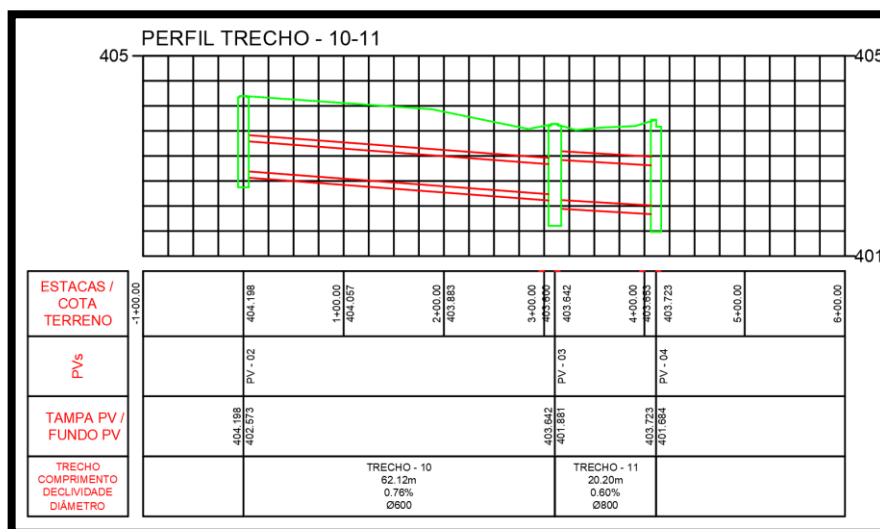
Perfil longitudinal – Av. Ajax Furquim, AutoCAD, CAD
